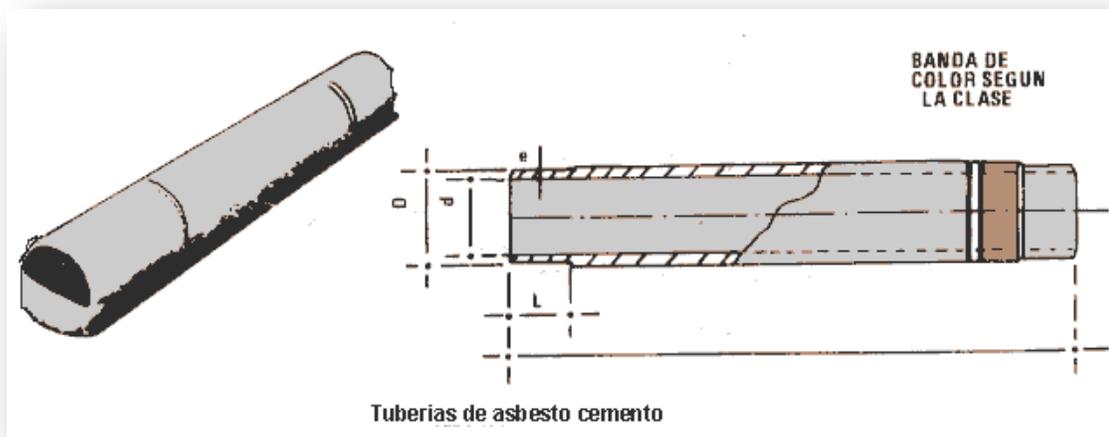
Tubería de asbesto-cemento, (Ref. 5)
